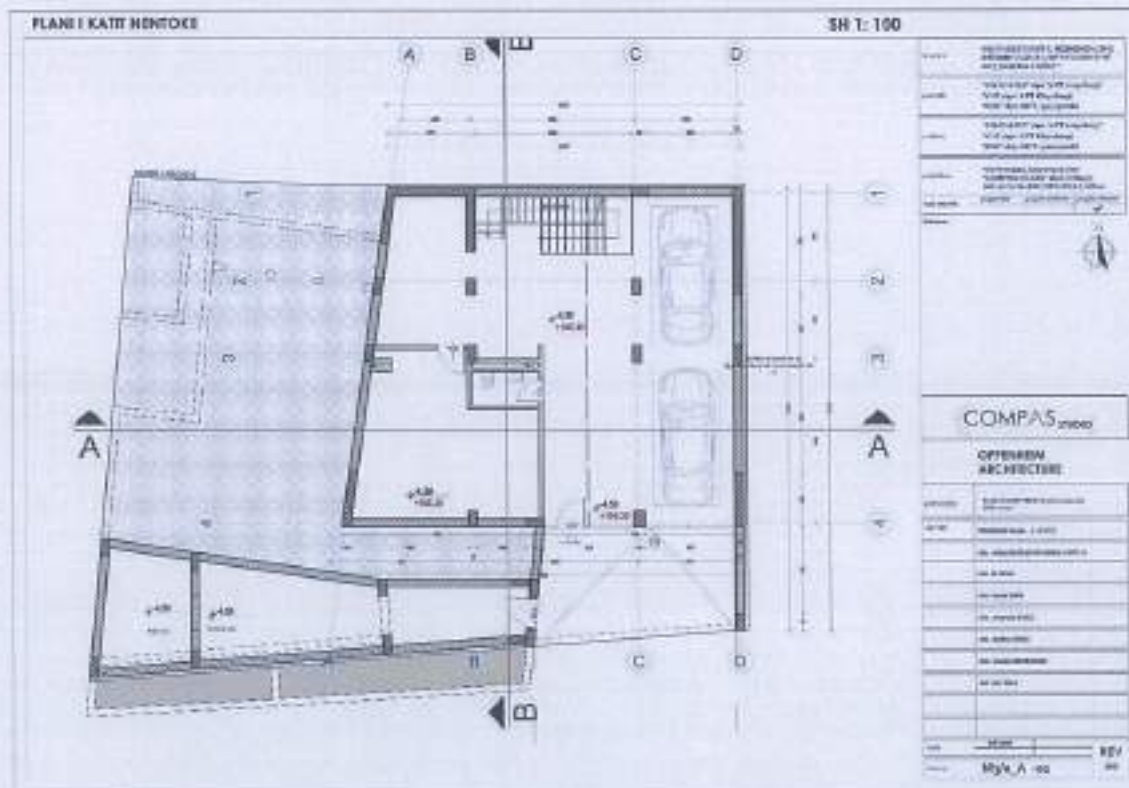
Vila M3/a \_ Planimetria e katit nëntokë
